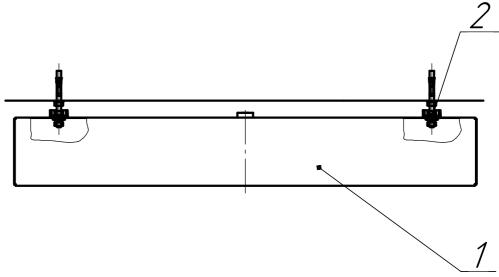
Установка светильника. 1. Светильник; 2. Узел подвеса.
